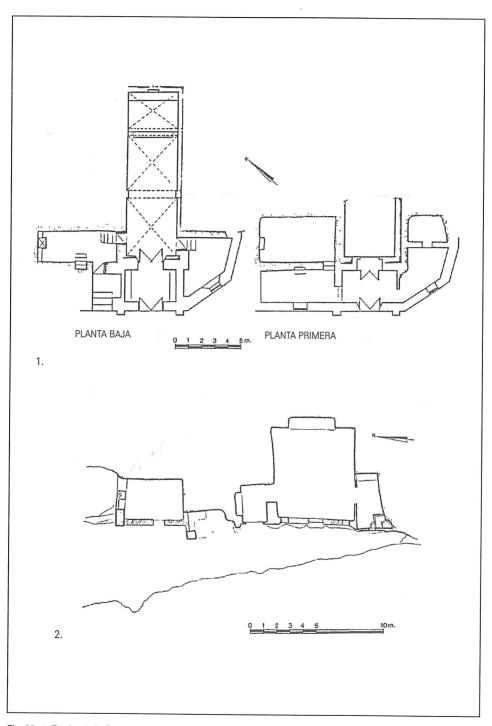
1. Ermita de la Fuensanta. Pizarra (Málaga). Planta (según: Puertas Tricas). 2. Iglesia rupestre. Villanueva de Algaidas (Málaga). Planta (según: Puertas Tricas)
